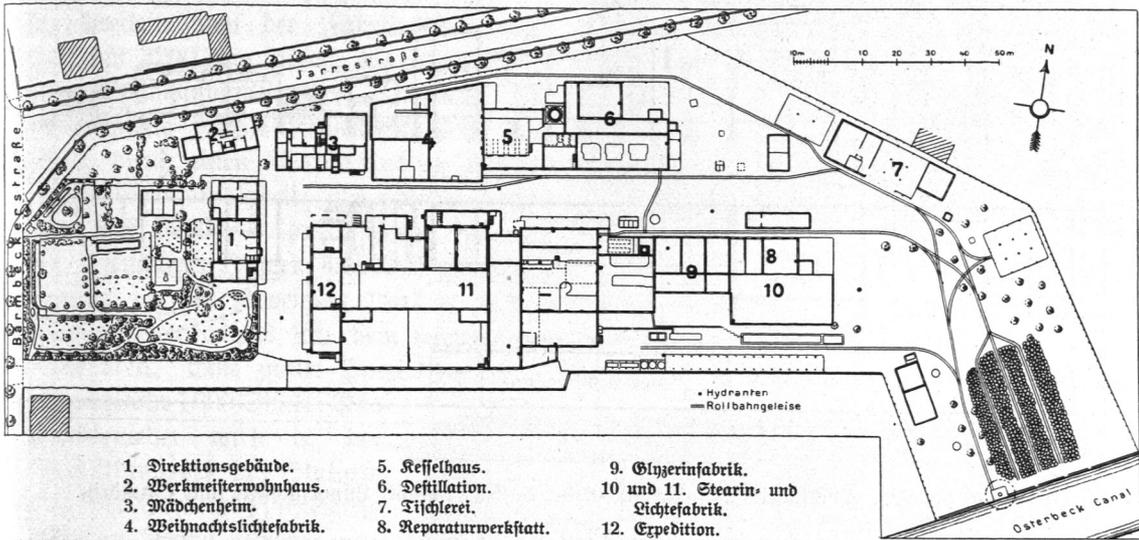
Hammonia-Stearin-Fabrik, Lageplan.
